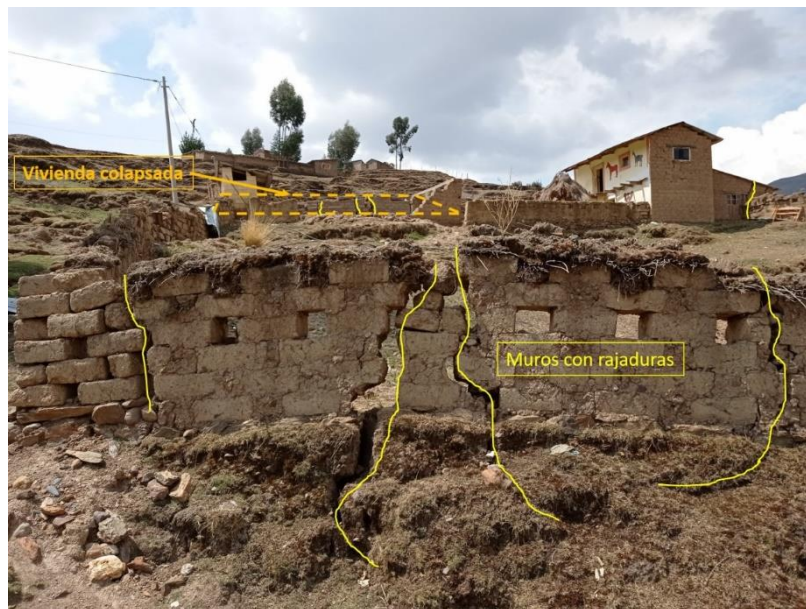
Vista tomada en coordenadas UTM E 238298; N 8466134. Se aprecian grietas en muros de las viviendas, además de una vivienda colapsada por el movimiento del suelo.
